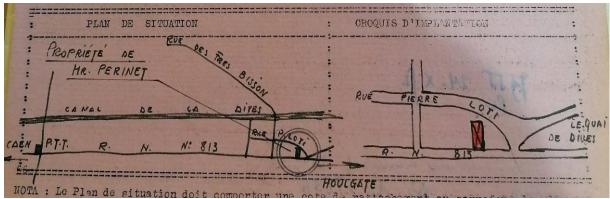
plan de situation de la poterie sinistrée à Dives (A.D. 14)
